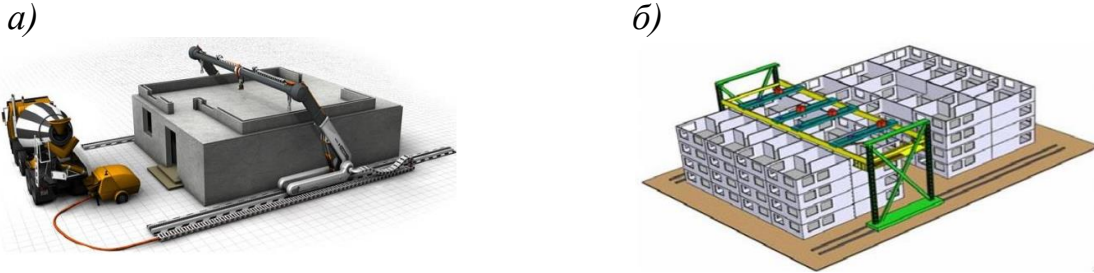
Загальний вид порталного 3D принтера: а – з двома опорами; б – з чотирма опорами
